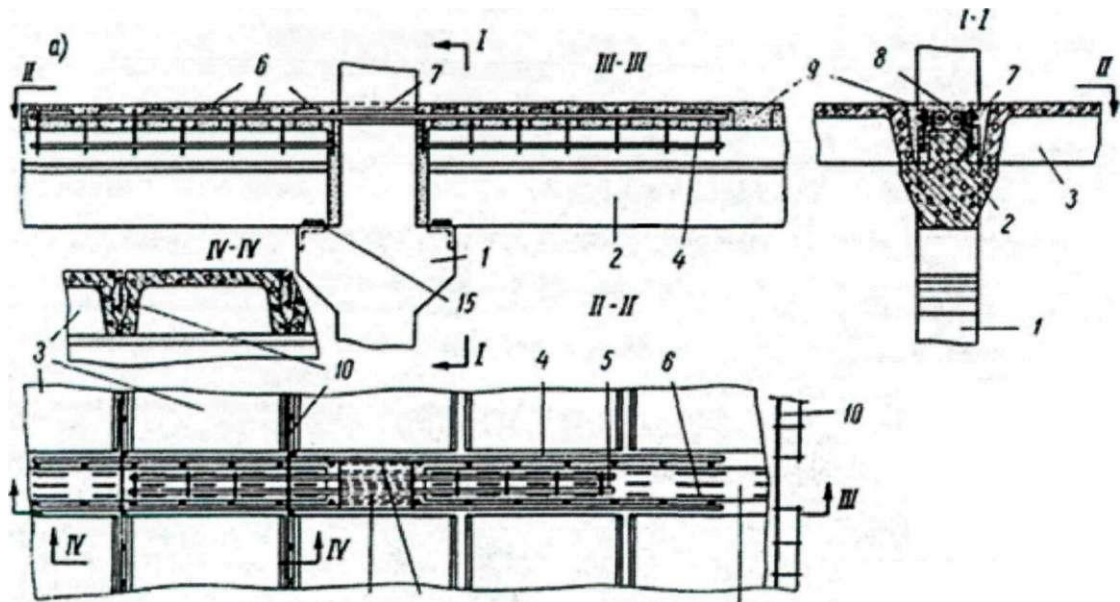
Вузол рами для типових багатоповерхових каркасних будівель серій ІІІ-60, ІІІ-61, ІІІ-62, ІІІ-63, ІІІ-64: 1- колонна рами; 2 - ригель рами; 3 - настил перекриття; 4- арматура зварного каркаса; 5-арматура над опорою із окремих стержнів; 6- арматура, випущена з елемента ригеля у вигляді хомутів-скоб; 7-паз в колоні для пропуску арматури; 8- отвори у колоні для пропуску арматури; 9 - зона замонолічування; 10 - каркаси (сідловидні) в швах настилу.
